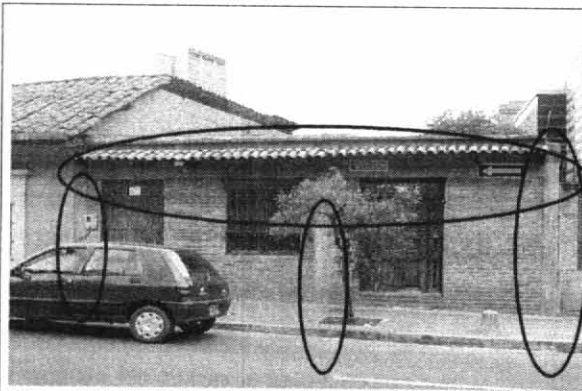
Fachada de la edificación en las condiciones presentes al momento de la visita. Muro aporticado.
